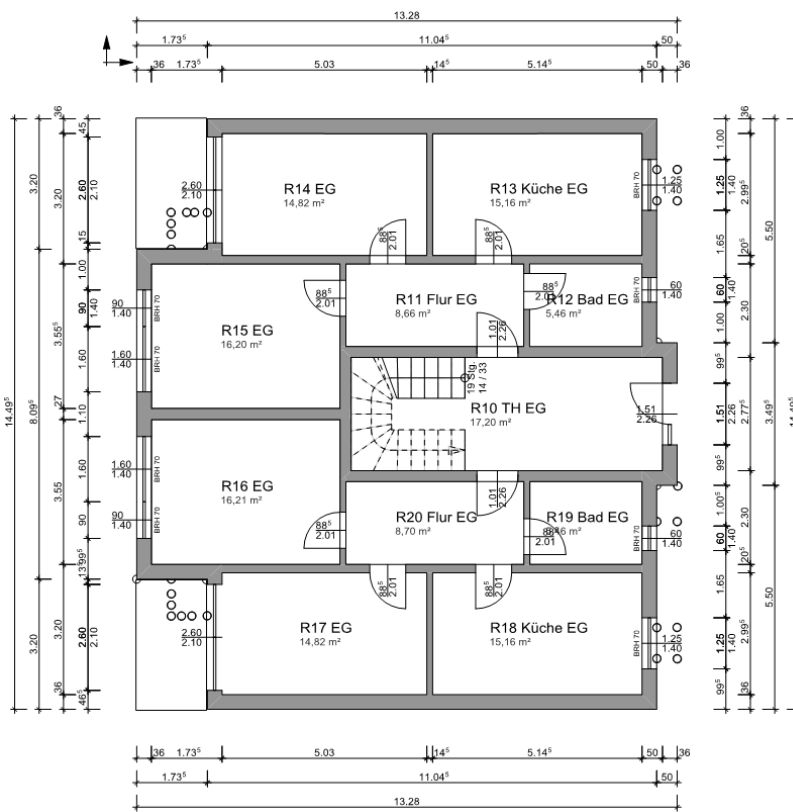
Grundriss Erdgeschoss Mehrfamilienhaus
